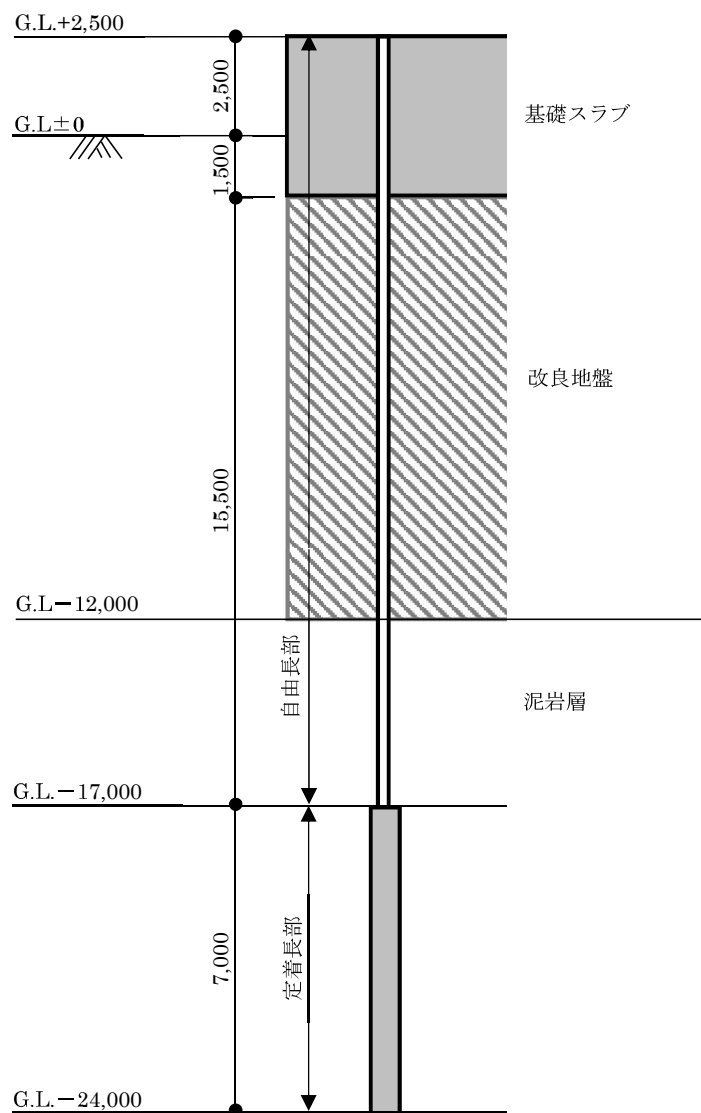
地盤アンカー設置計画 (単位: mm)
